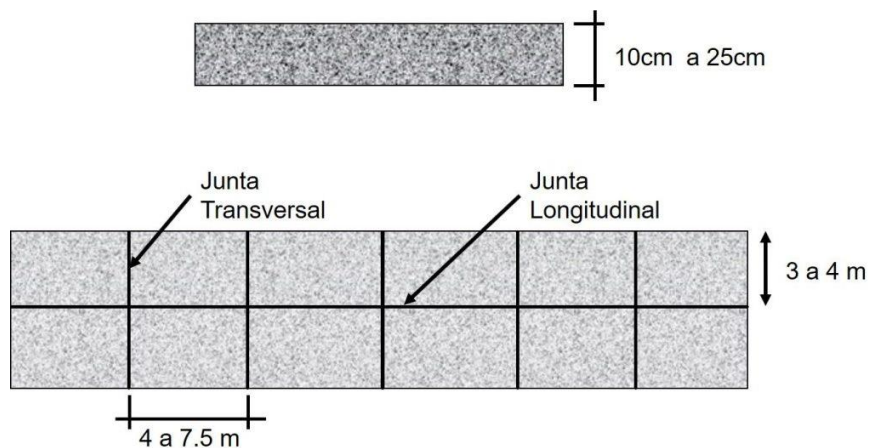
Juntas en el Pavimento de concreto [25, 32].
